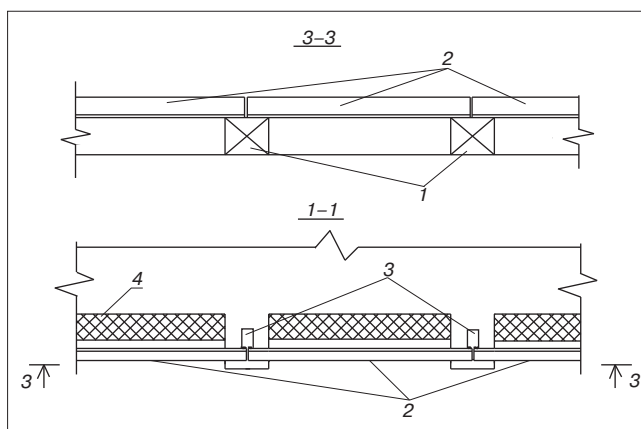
Облицовочная кладка-сечение 1-1 (разрез 3-3): 1 – консоль перекрытия; 2 – опорный уголок; 3 – закладная деталь; 4 – утеплитель
